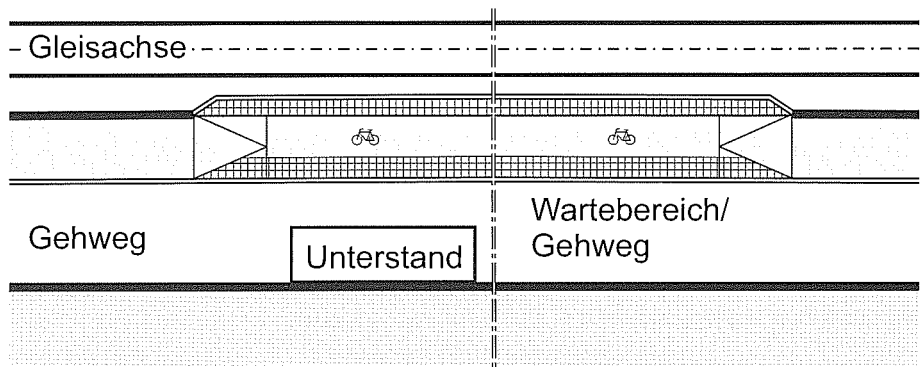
Prinzipskizze für die Ausbildung einer Haltestelle mit angehobener Radverkehrsführung
